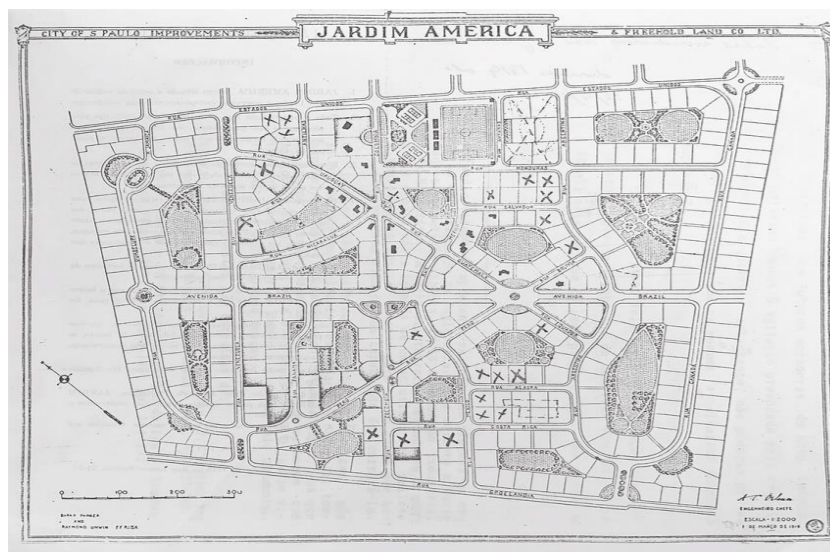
Planta do Jardim América tal como projetado por Urwin e Parker (Folheto de propaganda da City em 1919).
